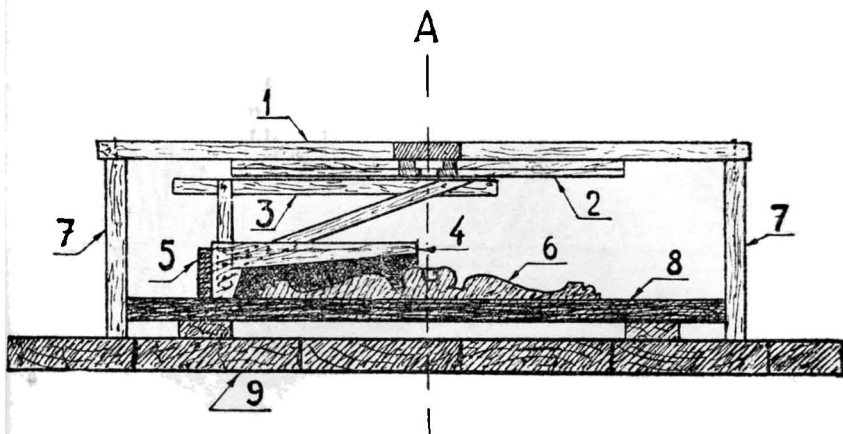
Схема устройства крестовины над щитом. 1 — основание крестовины, 2 — крестовина, 3 — рычаг, соединяющий крестовину с шаблоном, 4 — шаблон, 5 — полозок, 6 — профиль розетки, 7 — стойки, 8 — щит, 9 — верстак
